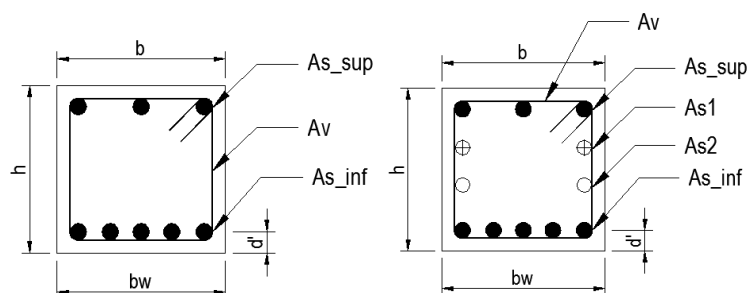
Nomenclatura de vigas (izquierda) y columnas (derecha) de hormigón armado.
